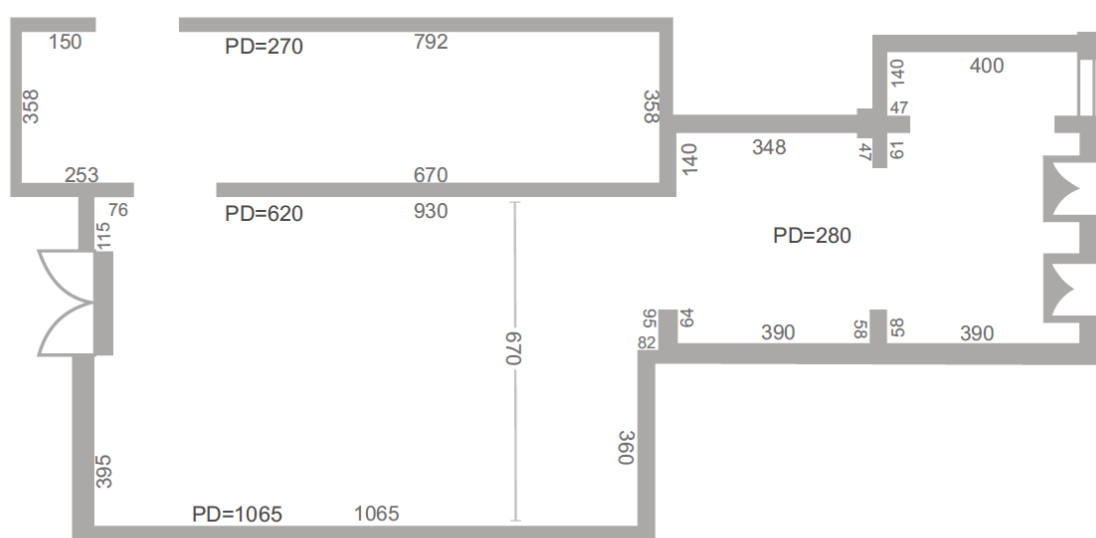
Planta baixa do pavimento superior do prédio principal do MAC-PR
